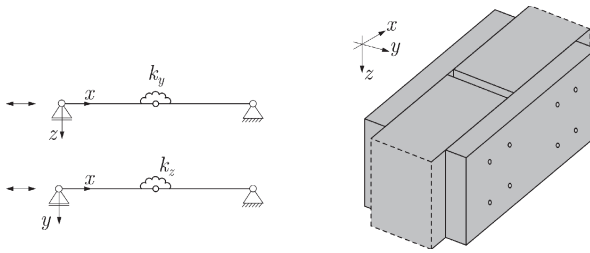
Druck- oder Zugstoß mit seitlichen Laschen.
